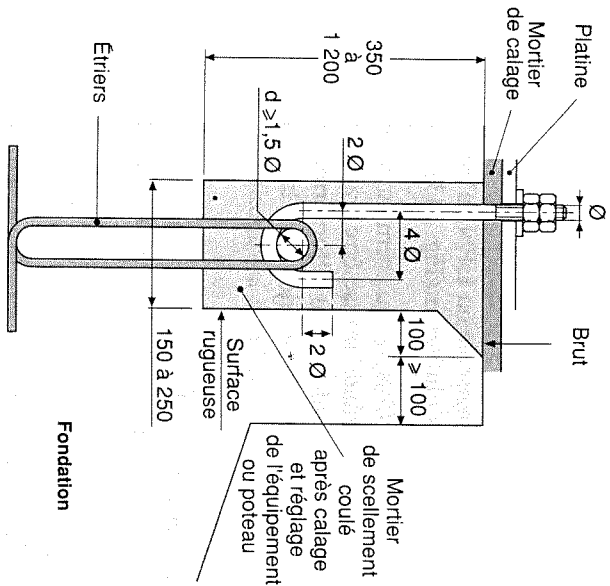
Détail d'ancrage des tiges avec clé d'ancrage.
